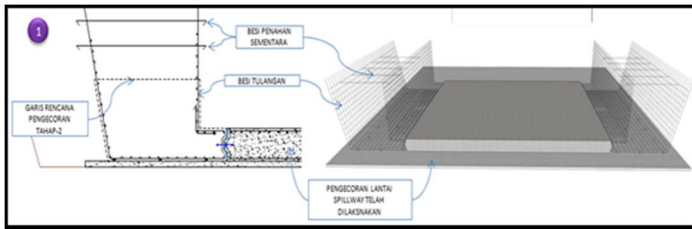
Tahapan pengecoran pada bangunan pelimpah (*spillway*)
